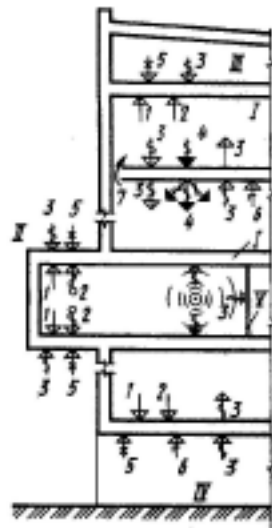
Схема распределения воздействий среды на перекрытия и перегородки:
